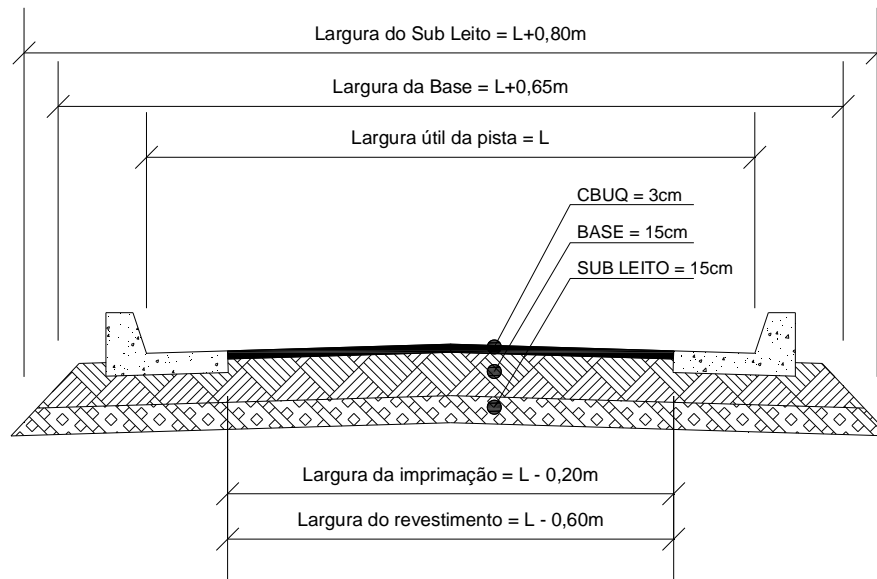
Larguras das camadas do pavimento, das pistas de tráfego local, para caimento duplo (abaulada)
